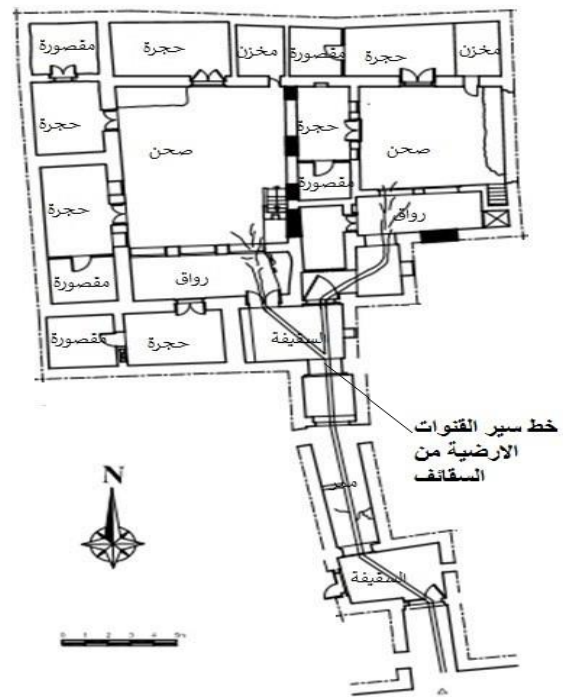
مسقط أفقى للطابق العلوي لمنزل الوادى
